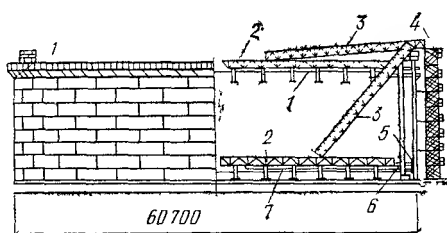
Вертикальный цилиндрический резервуар объемом 50 тыс. м<sup>3</sup> с плавающей крышей
